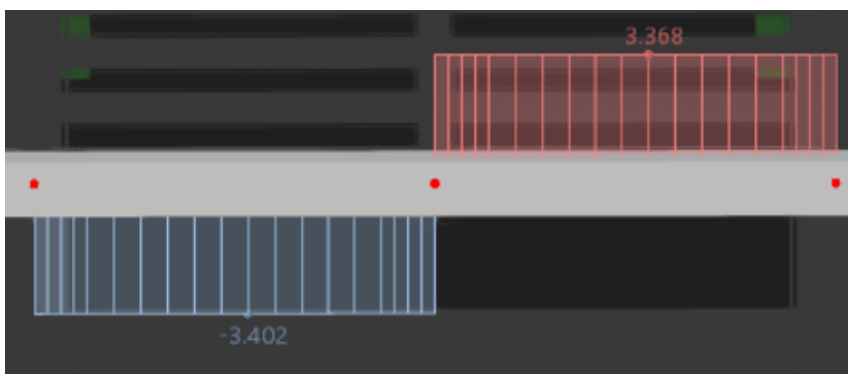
Esfuerzo de corte por cargas permanentes de cubierta y equipos en viga puntal V110
